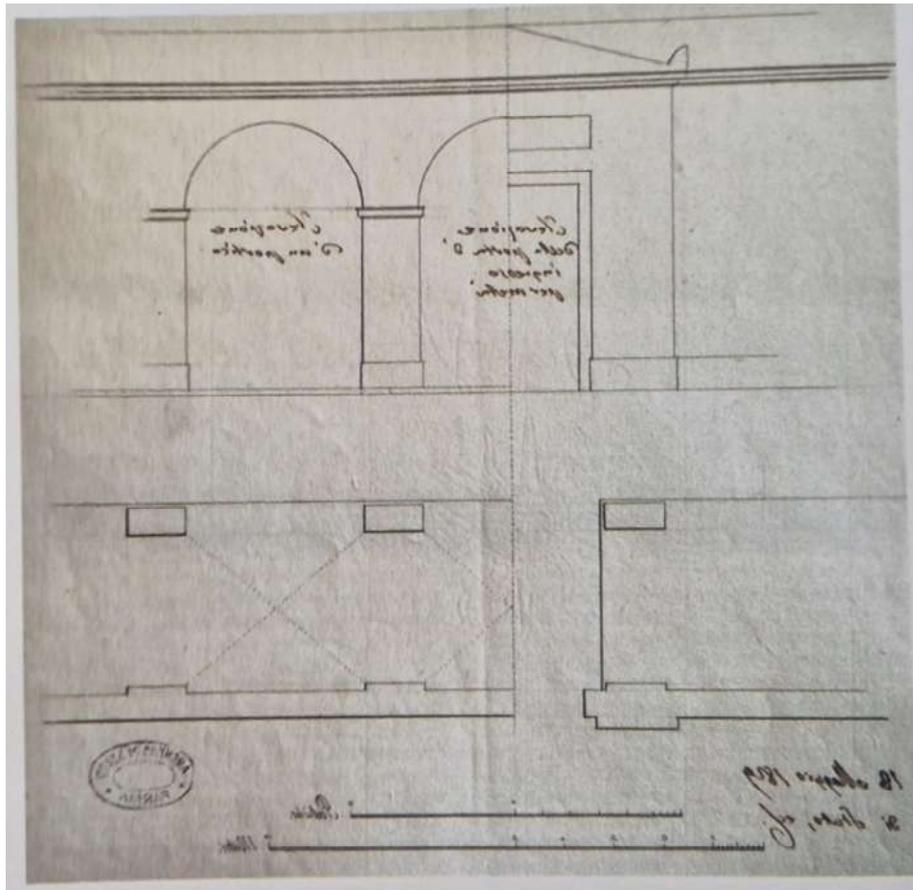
S.A., Pianta ed elevazione della porta d'ingresso e di un portico del cimitero, 18 Maggio 1824 in ASPR, Governatorato di Parma, 1817, b. 543
